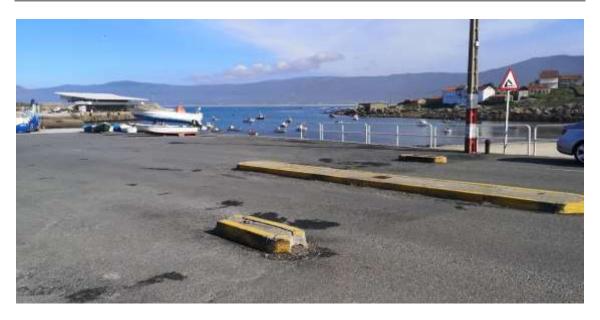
Acceso principal al puerto. Fuente: ACADAR
